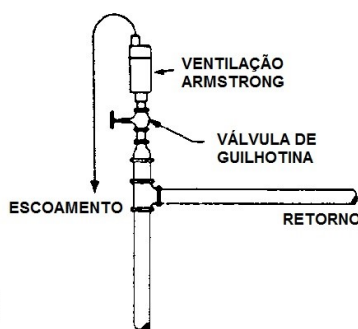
Instalação de ventilação automática em sistema de ponto alto
